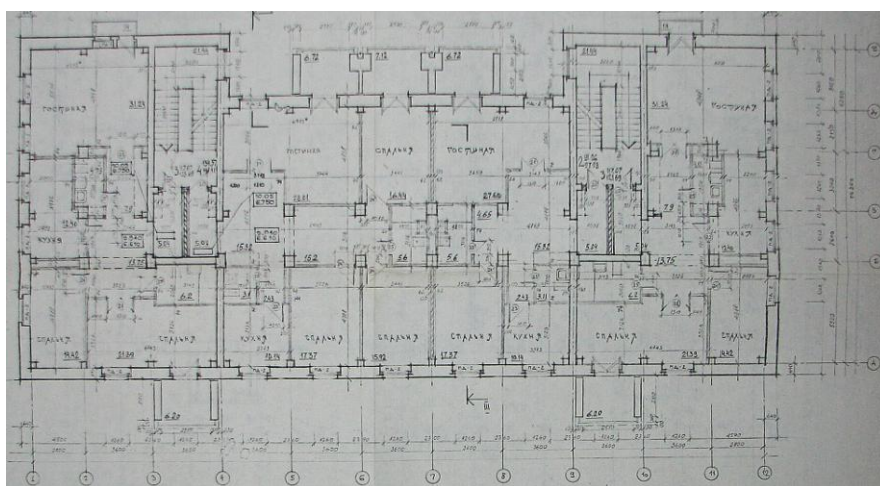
Жилой дом по пр. Мира, д. 122Б. План 2-4 этажей
